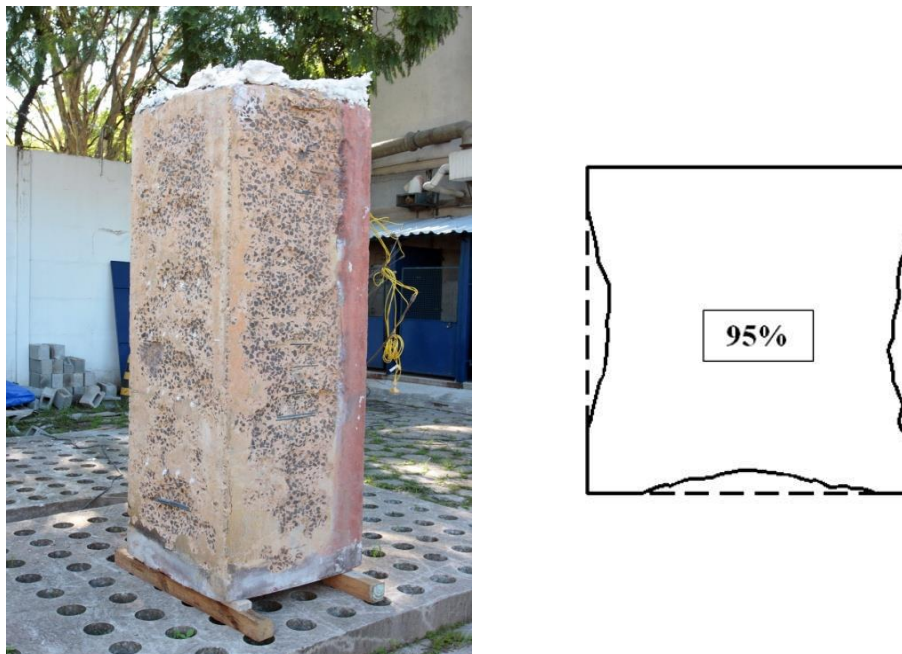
Integridad del pilar y detalles transversales conservados después de una prueba de 180 min (3 h) (que muestra la pequeña reducción de la sección transversal sufrida solo por el spalling) (Britez, 2011).
